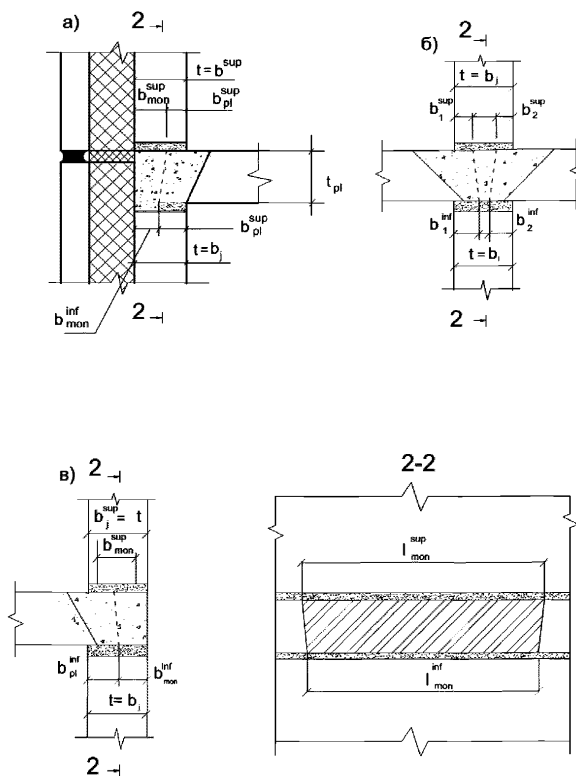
Платформенно-монолитные стыки: а – наружная стена; б – двусторонний стык внутренних стен; в – односторонний стык внутренних стен
